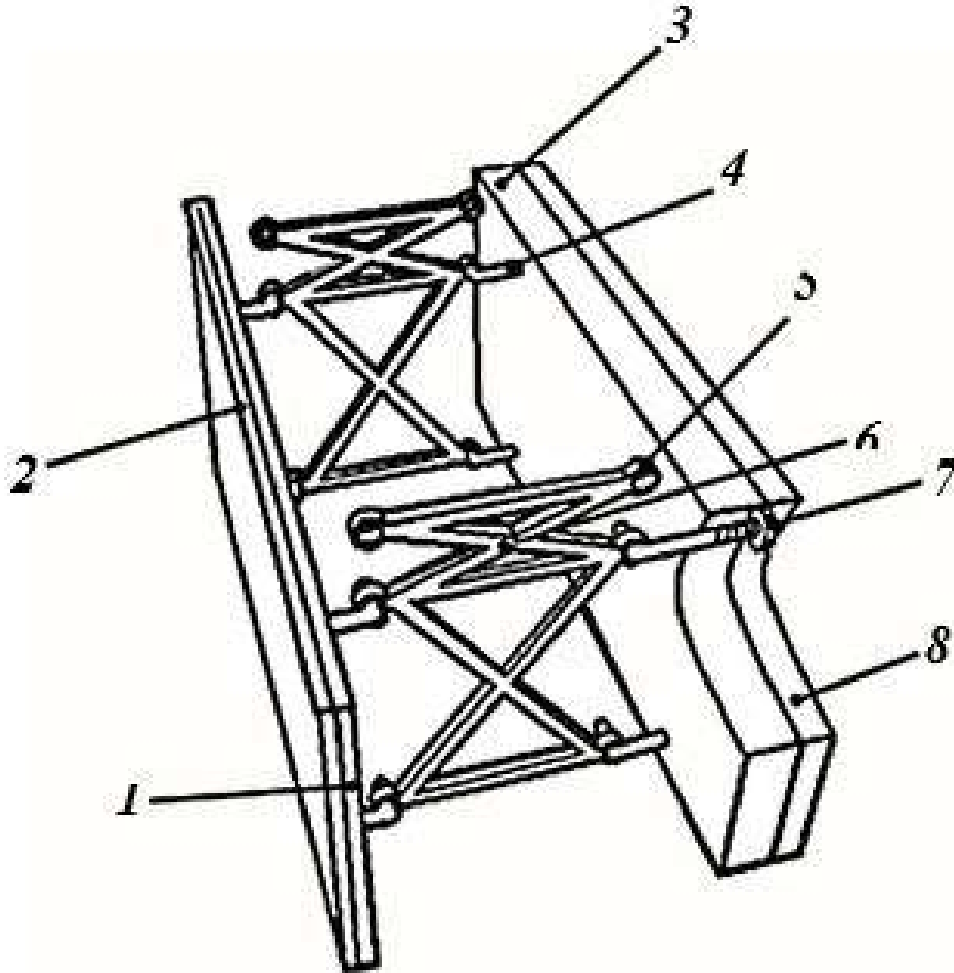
Конструктивно-технологічна схема модуля з бетонних плит з декоративним покриттям: 1 – зовнішня бетонна плита; 2 – облицювальна плита; 3 – пластина утеплювача; 4 – монтажні крюки; 5 – монтажні проушини; 6 – пластикова стяжка; 7 – закладна гайка; 8 – внутрішня бетонна плита
